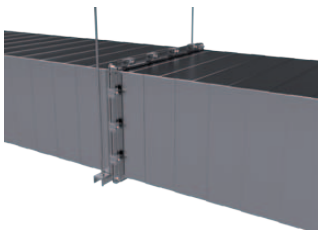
Rohové styky desek jsou spojeny požárními vrtů Fire Screw
